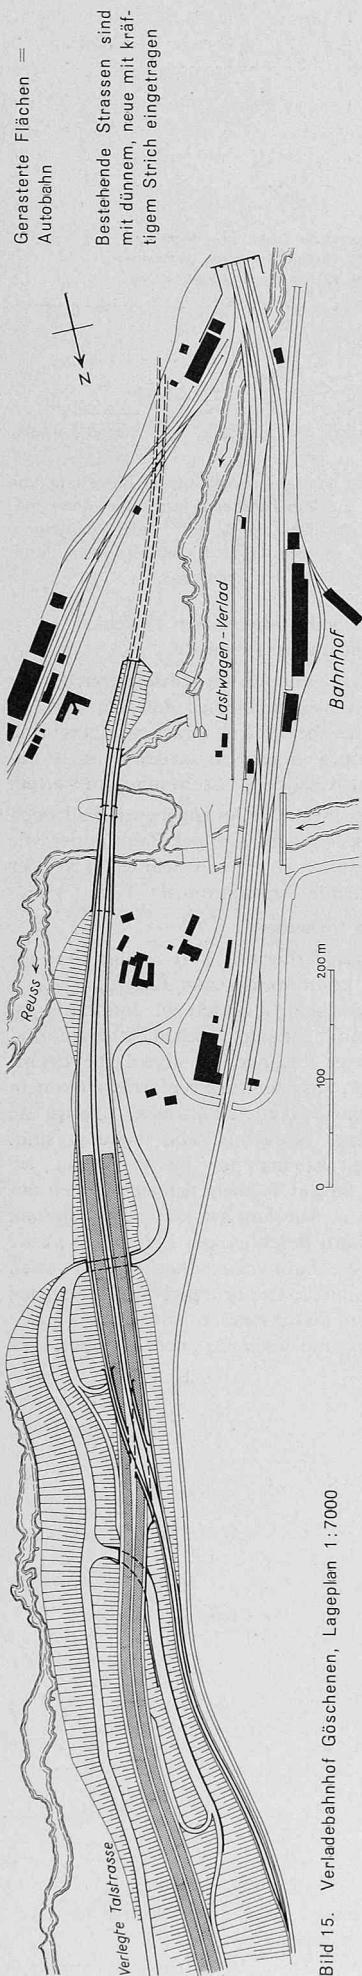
Verladebahnhof Göschenen, Lageplan 1:7000
